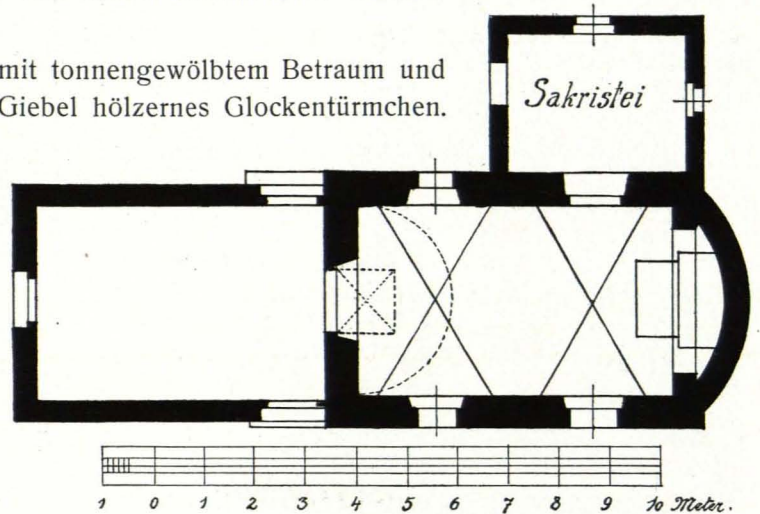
Viehhausen. Kapelle, Grundriß 1 : 150 (S. 472)
